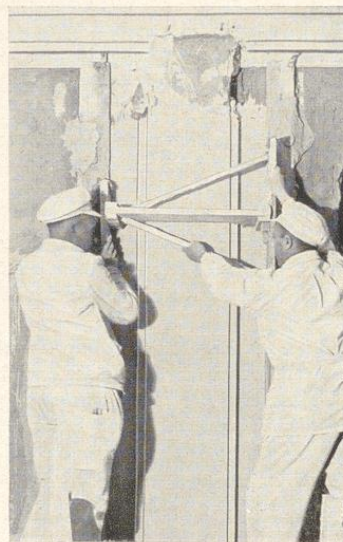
Wandzug eines Pilasters mit Mittelschablone
